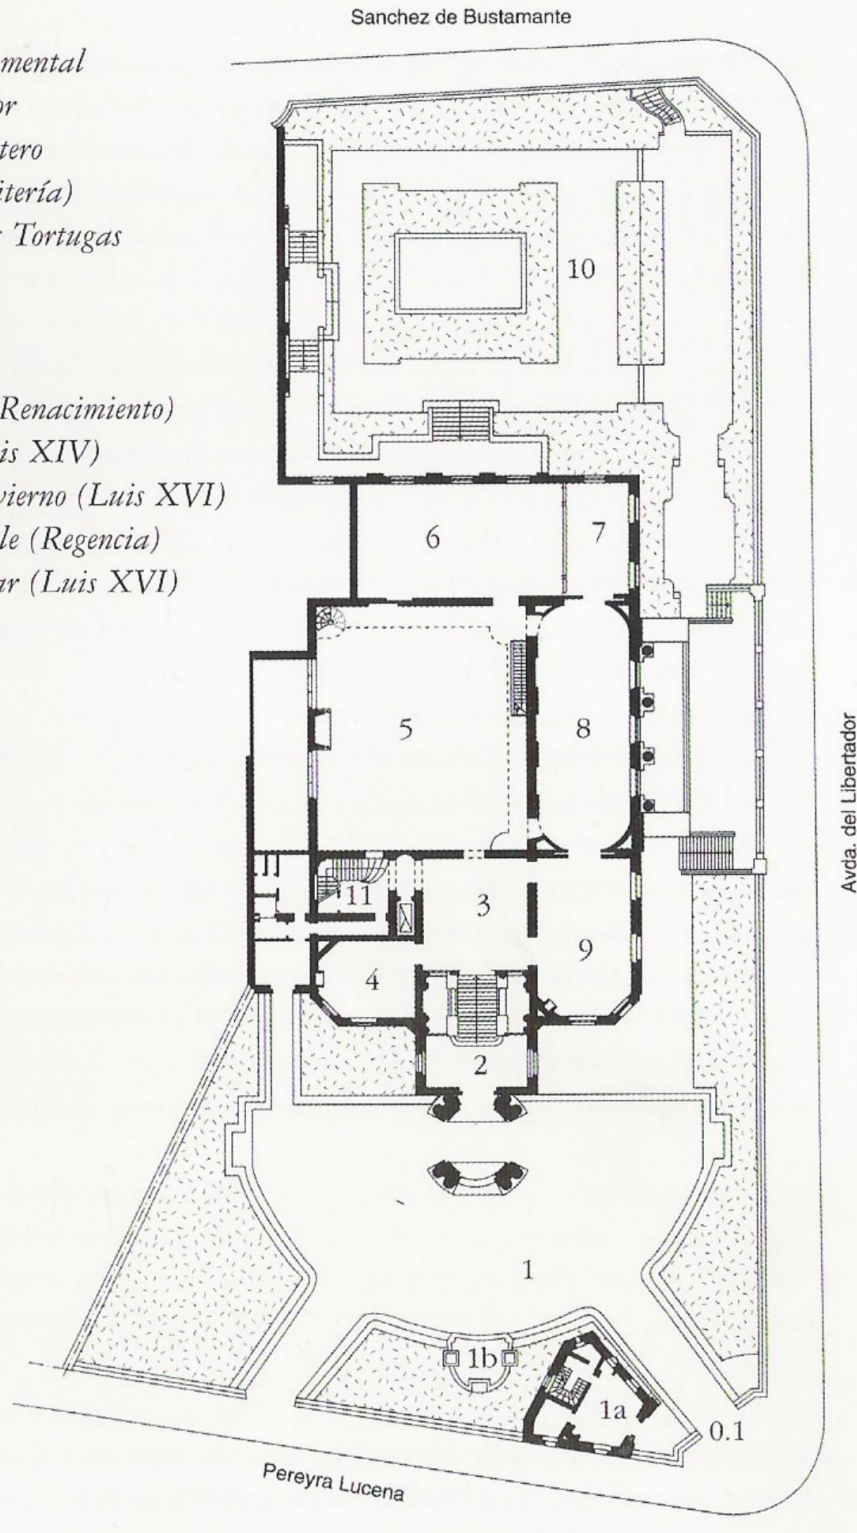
Plano de planta Baja de la residencia Errazuriz-Alvear.
